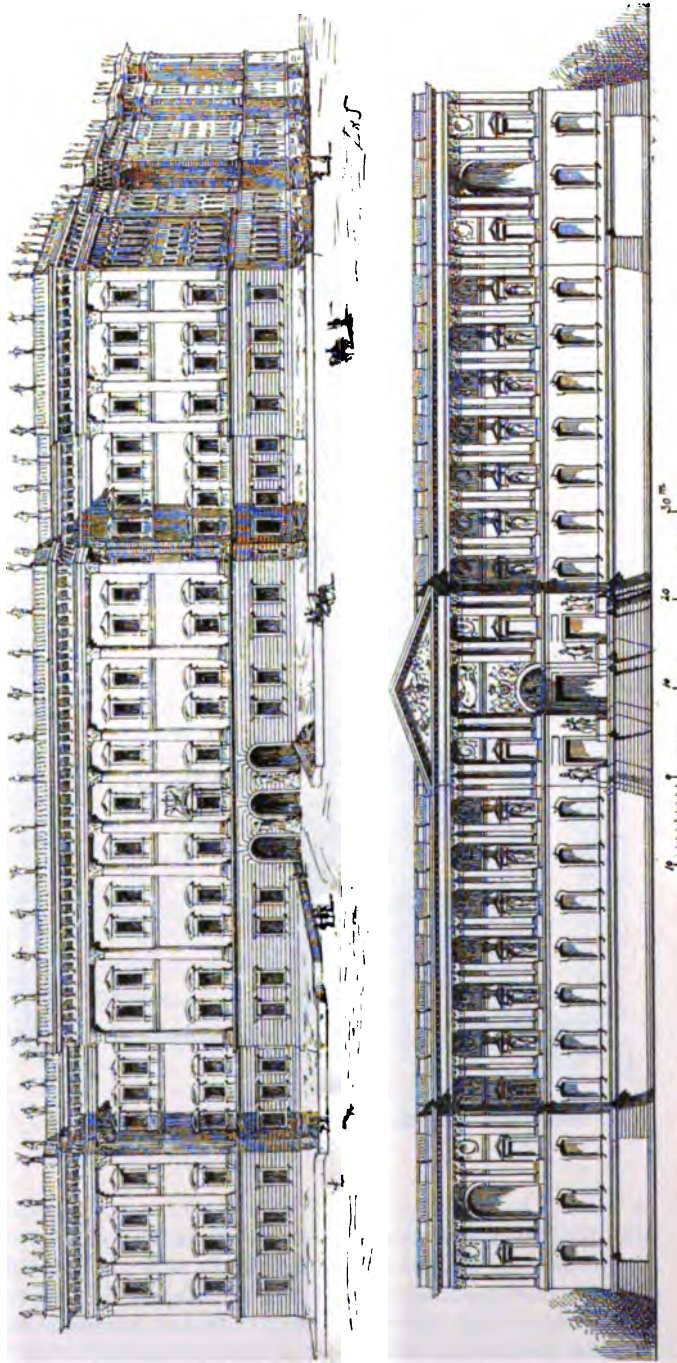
Berninis Plan für die Louvrefassade — Fig. 63 Perraults Plan für die Louvrefassade
